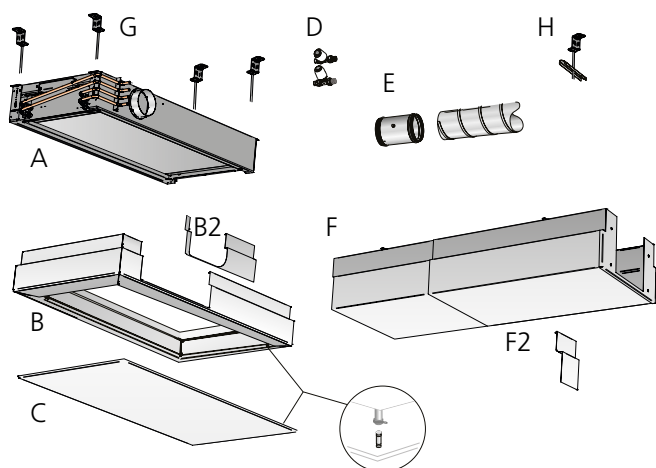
Prinzipskizze für die Aufhängung von PARASOL EX und Abdeckung
